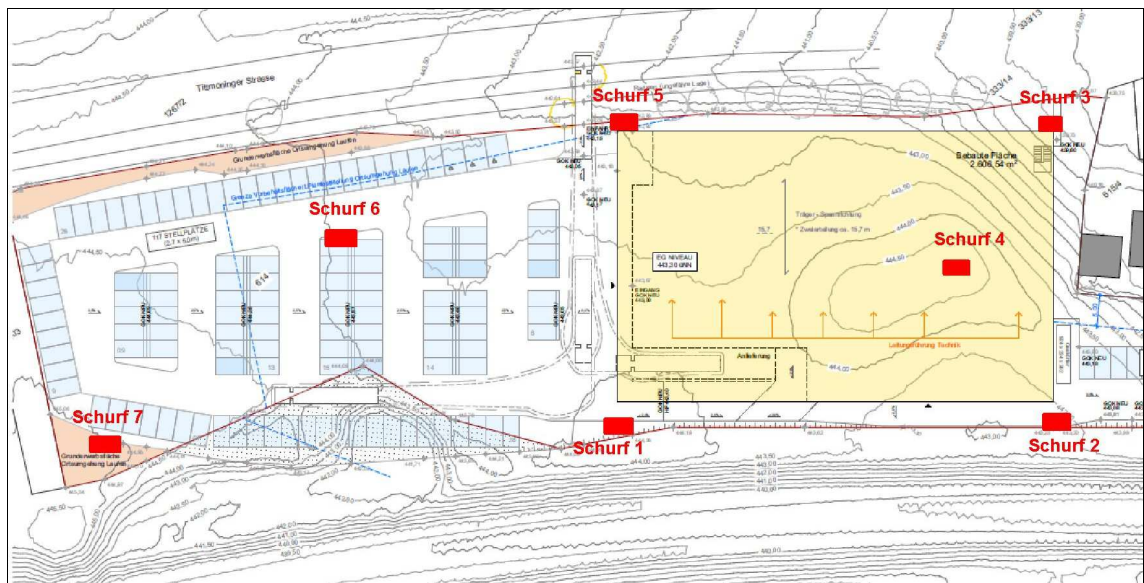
Lageplan Ausschnitt (ohne Maßstab) mit Lage der Schürfe zum Bodenaufschluss
